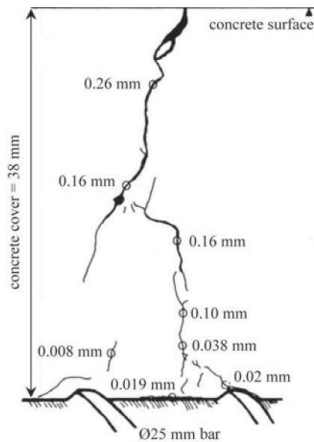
Rissbreitenmessungen im Bereich der Betonüberdeckung (aus Beeby 1978)
